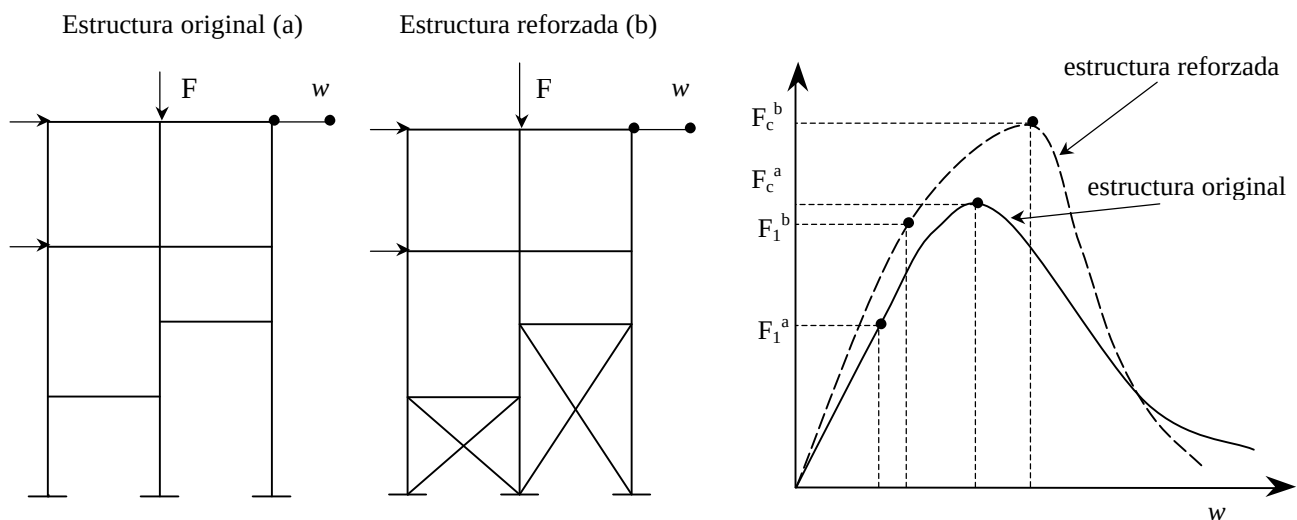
Evaluación de la intervención de restauración sobre un pórtico plano.
